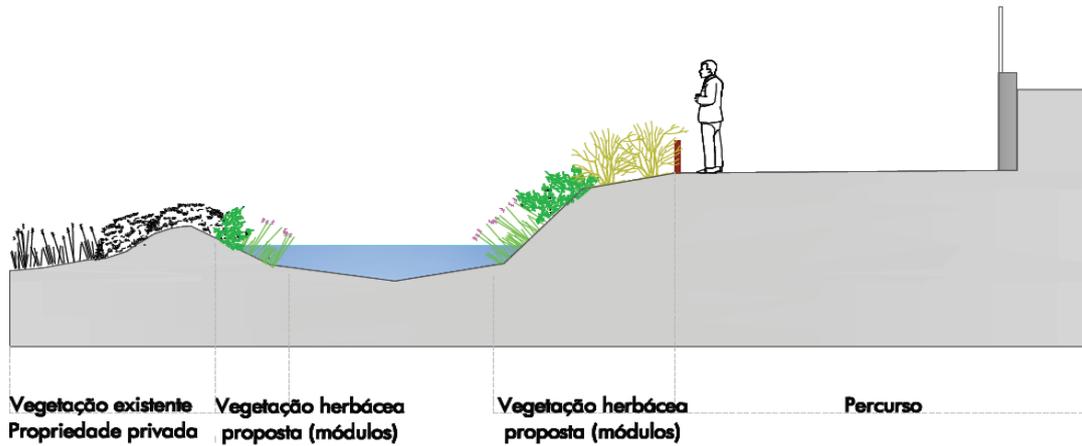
Corte transversal tipo – proposto; subtrço 4 (vista de jusante); Vânia Rodrigues
